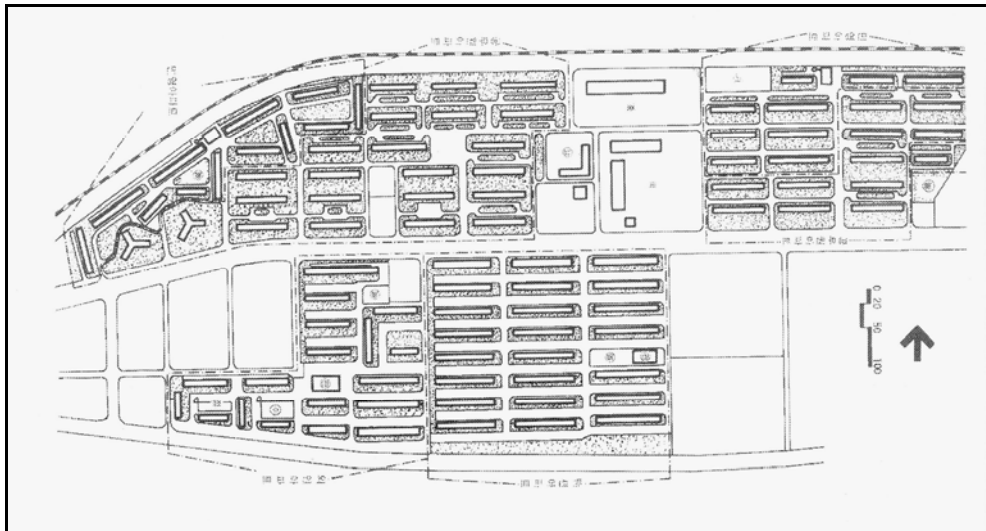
Lageplan der Wohnsiedlung Dongbuitschon
